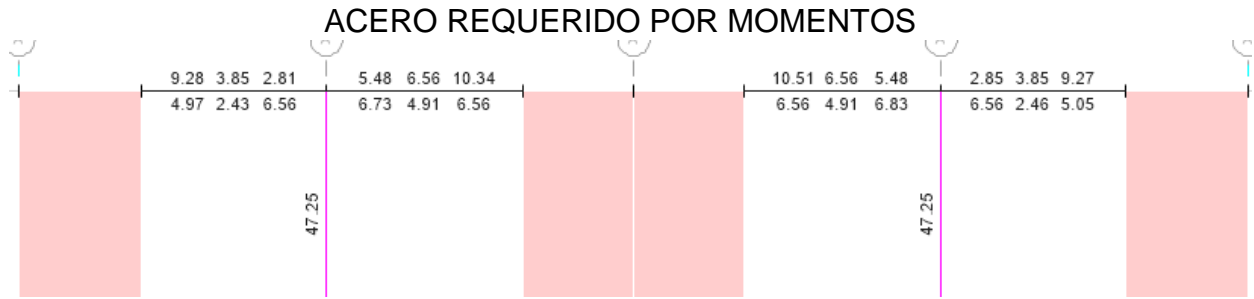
Acero Requerido por momentos en Vigas 8° Piso
